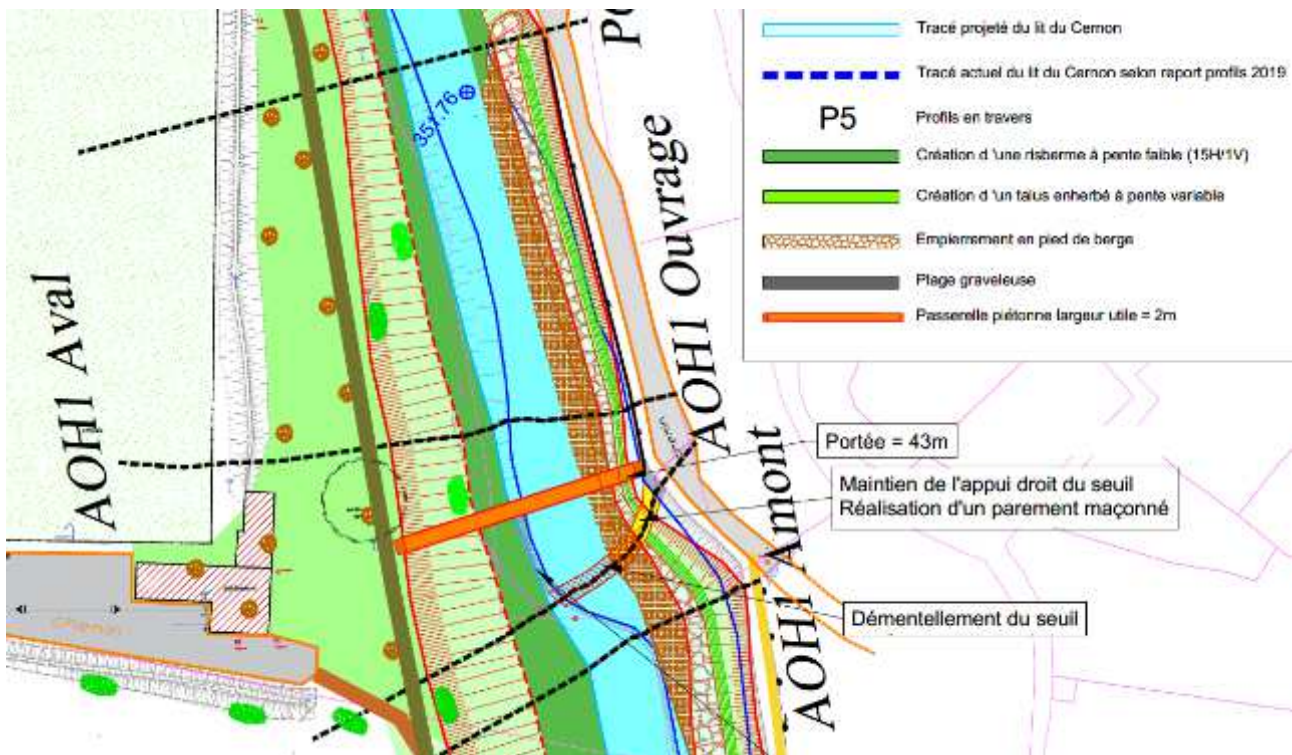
D'IMPLANTATION PROJETEE DE LA PASSERELLE PIETONNE
